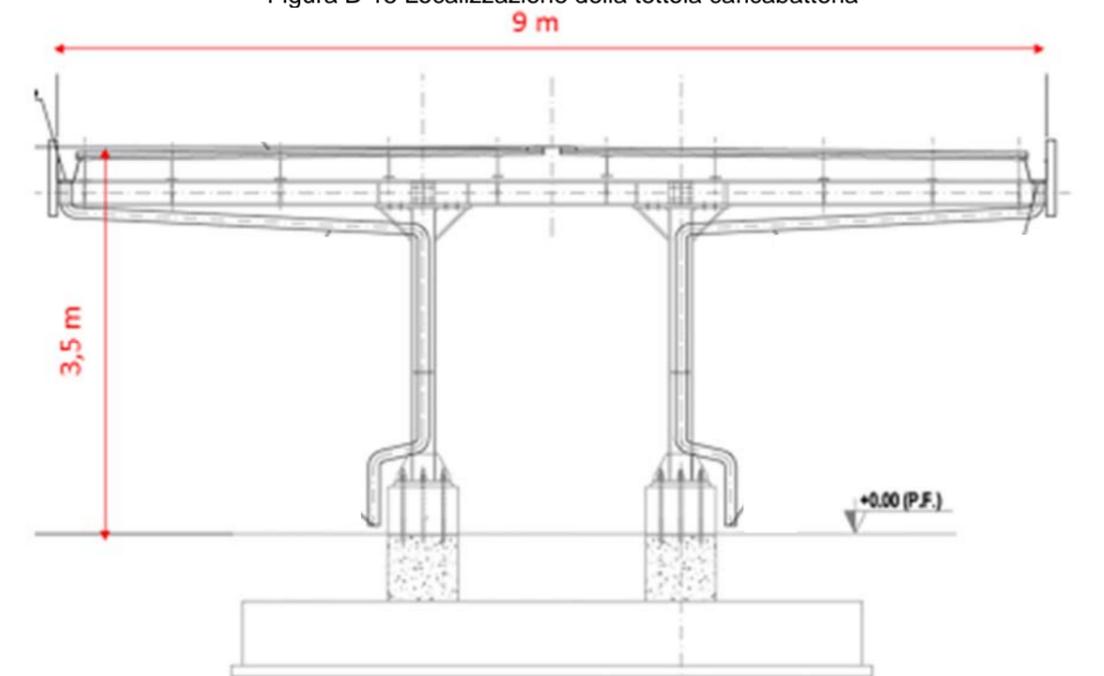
Vista in sezione della tettoia metallica caricabatteria
